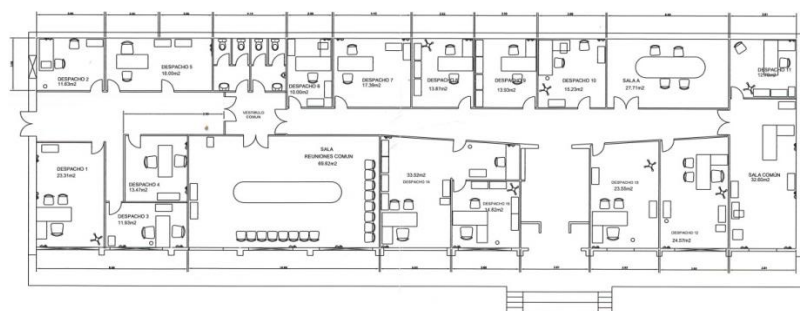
Planta del barracón. Fuente: (AVVMV, 2016).
